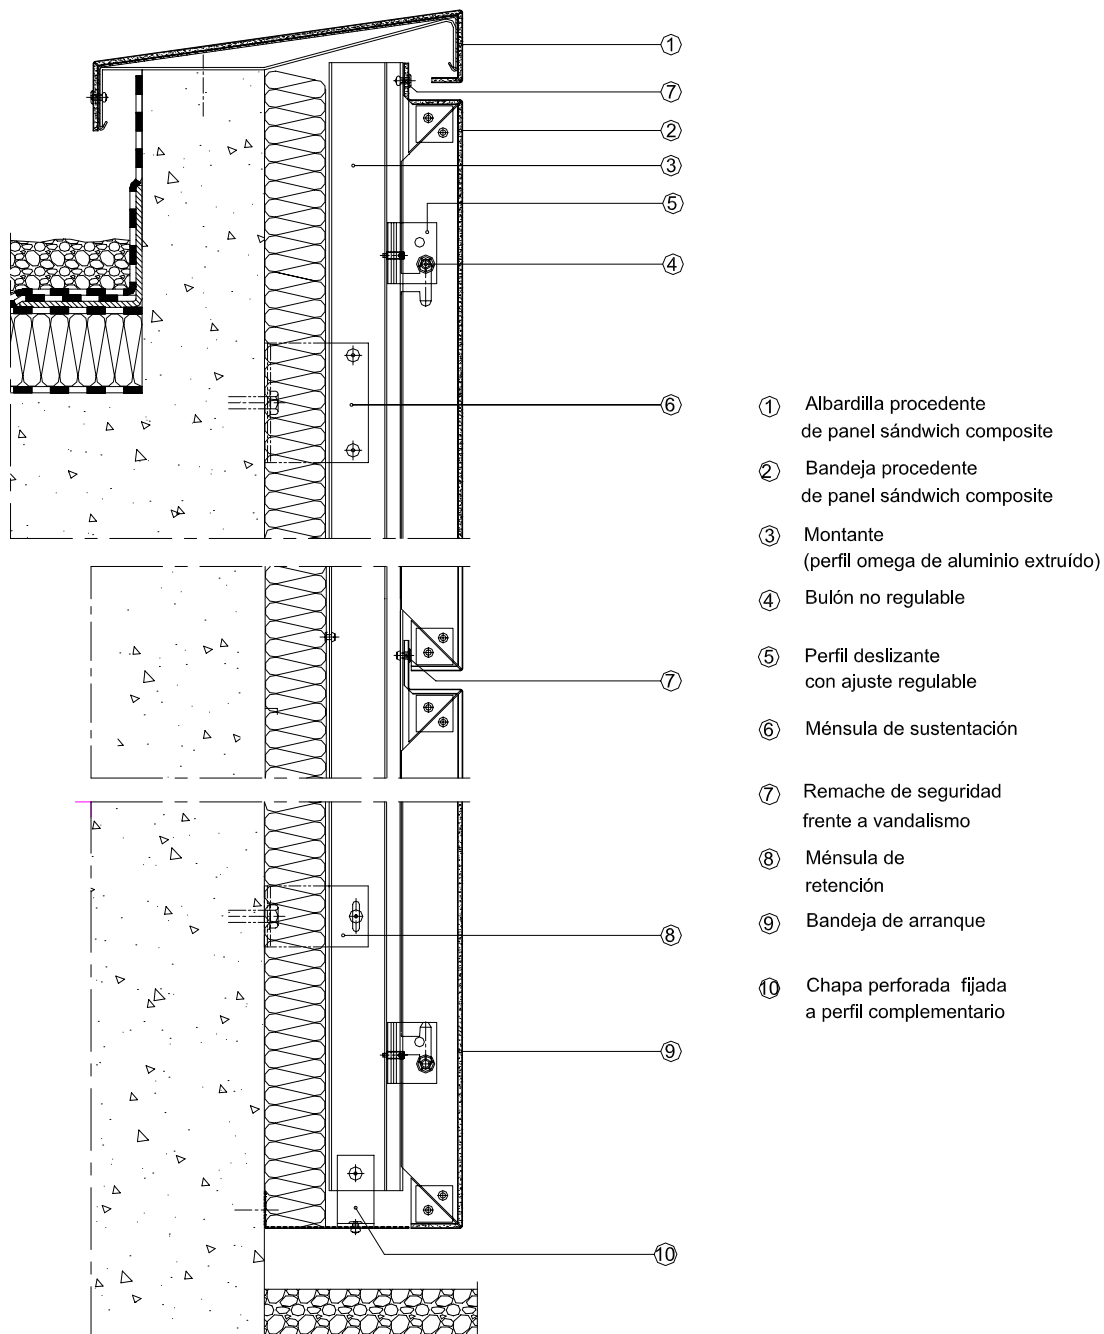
Detalle de arranque, junta horizontal y coronación entre fachadas
